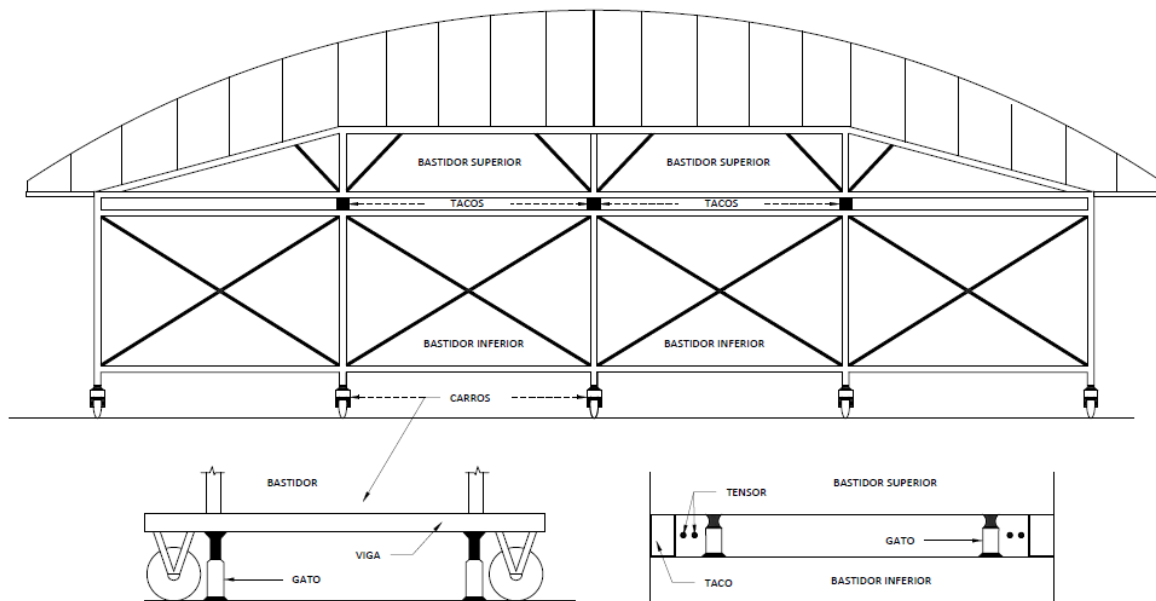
Cimbra móvil tipo. Fuente: Elaboración propia
